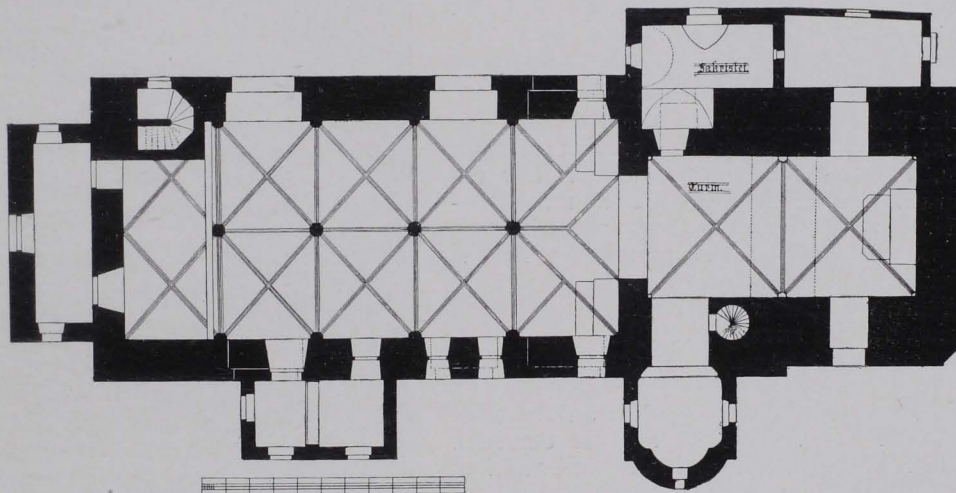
Thaya, Pfarrkirche, Grundriß 1 : 300 (S. 139)
